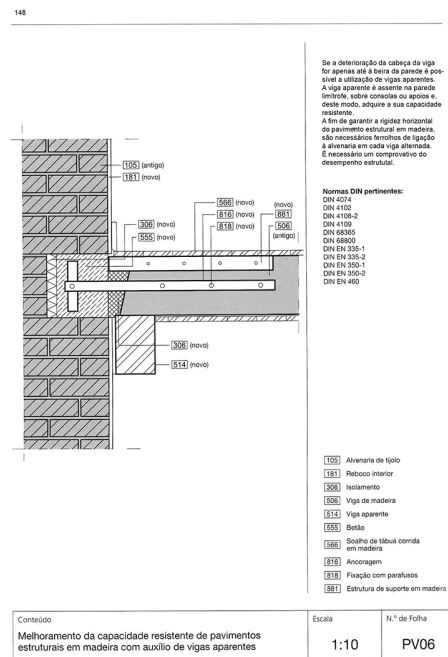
Pormenor construtivo do melhoramento da capacidade resistente de pavimentos estruturais com auxílio de vigas aparentes, reabilitação.
